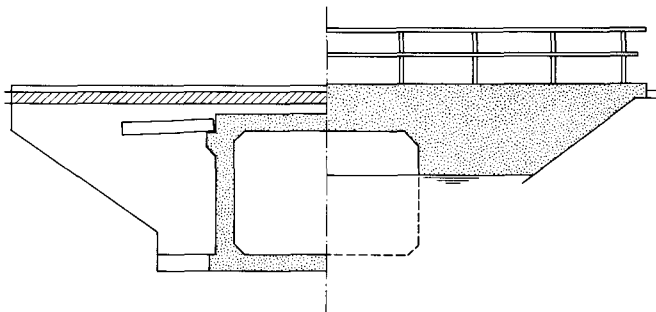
Voorbeeld van een geprefabriceerd betonliggersysteem met gedeeltelijke prefab randbalk en ter plaatse gestorte constructie (druk)laag.
